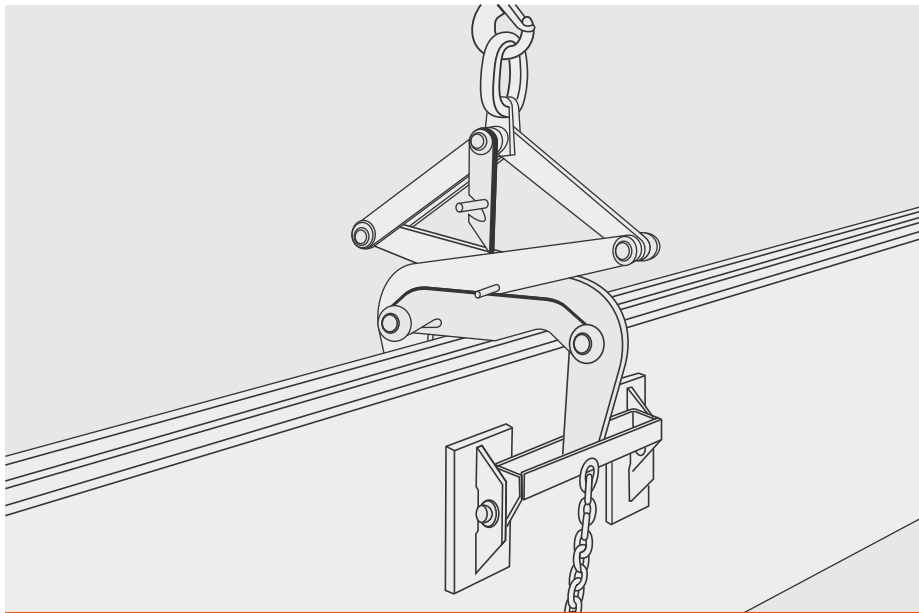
Tenaza Tijera para montaje de panel en posición horizontal.
